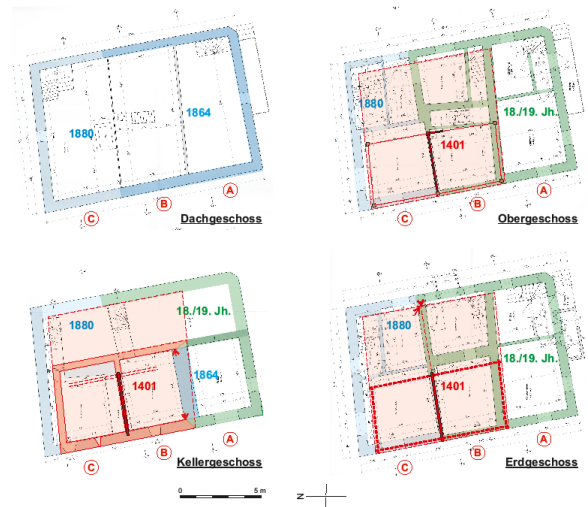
Grundrisse mit der Bezeichnung von Bauphasen, 1:200.
